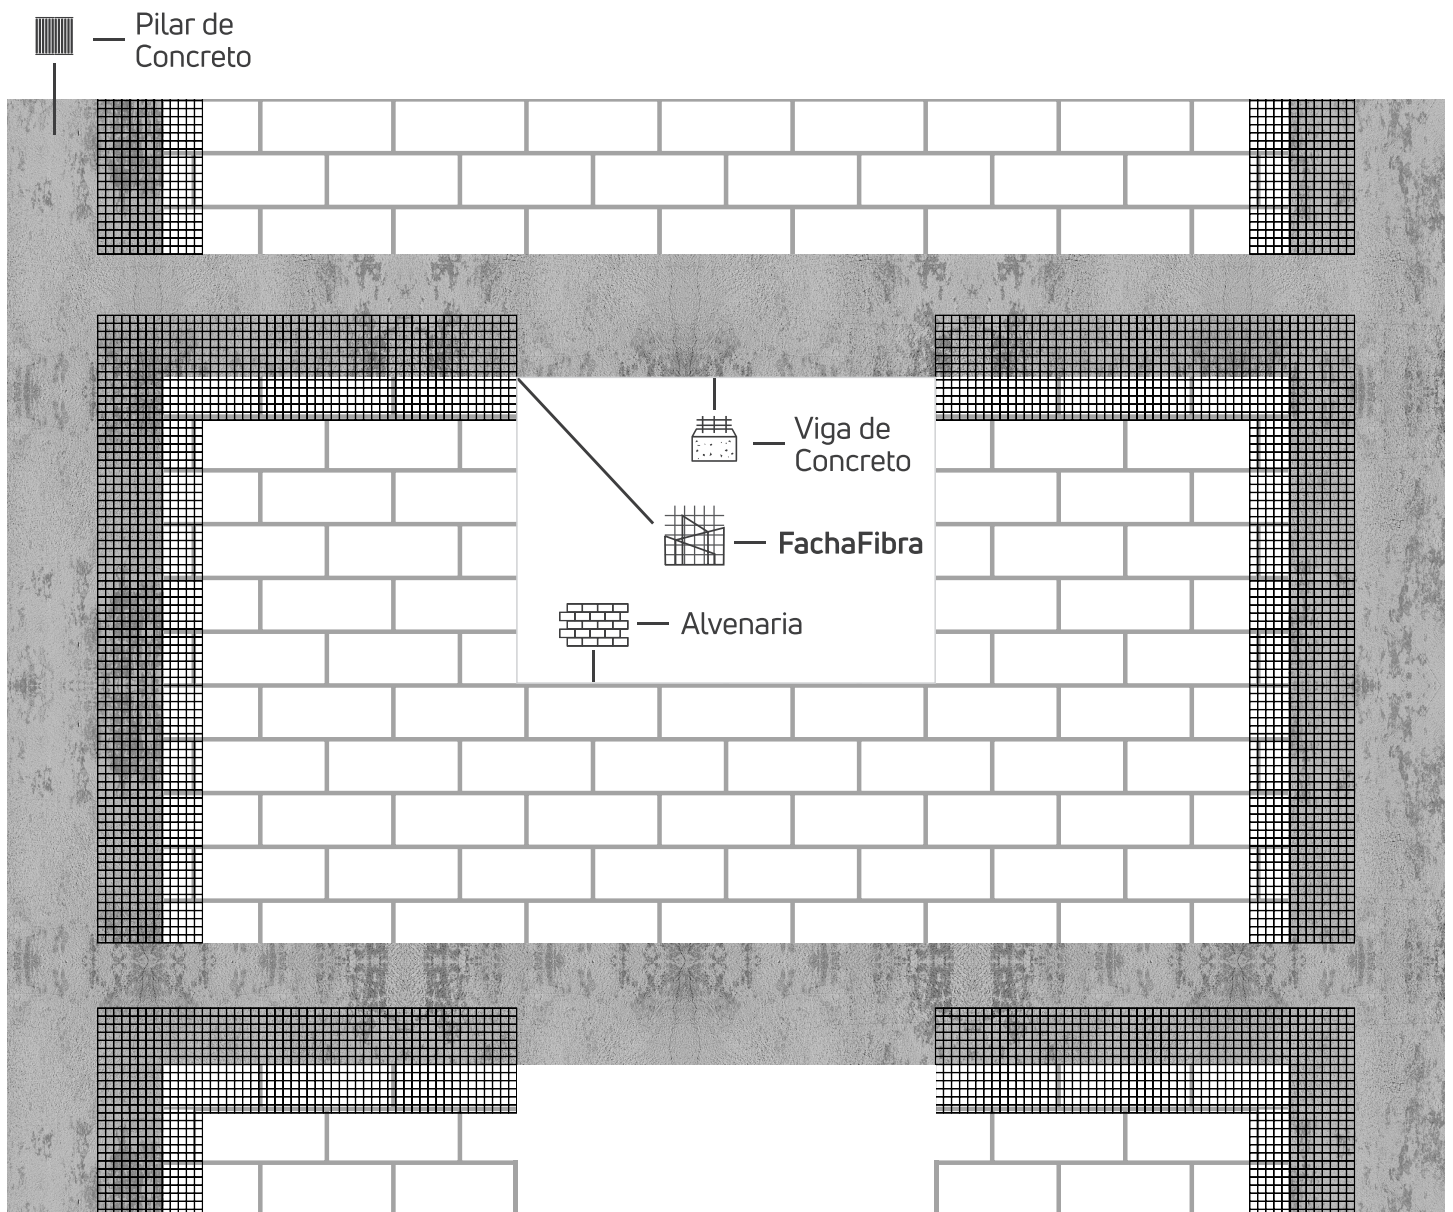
Posicionamento da FachaFibra para reforço do revestimento de argamassa nas interfaces entre alvenaria de vedação e estrutura de concreto armado (vigas e pilares)
